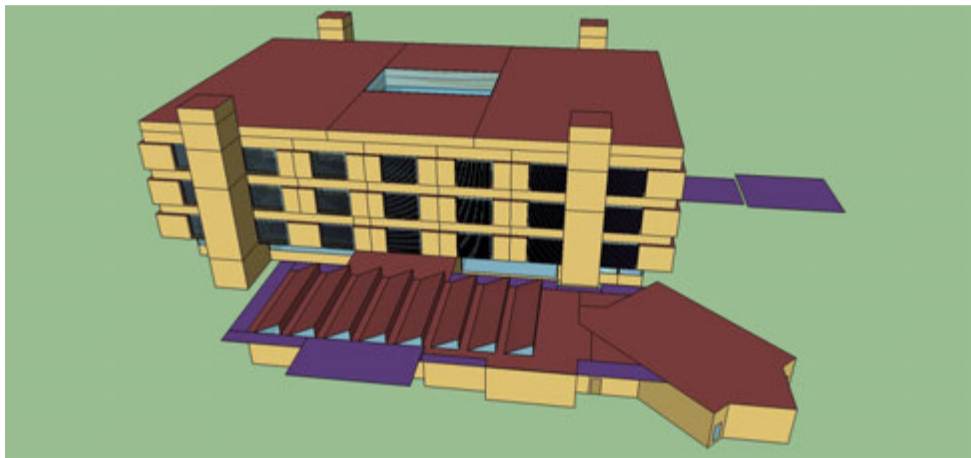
Edifício real modelado. Fachada principal, vista SO.
